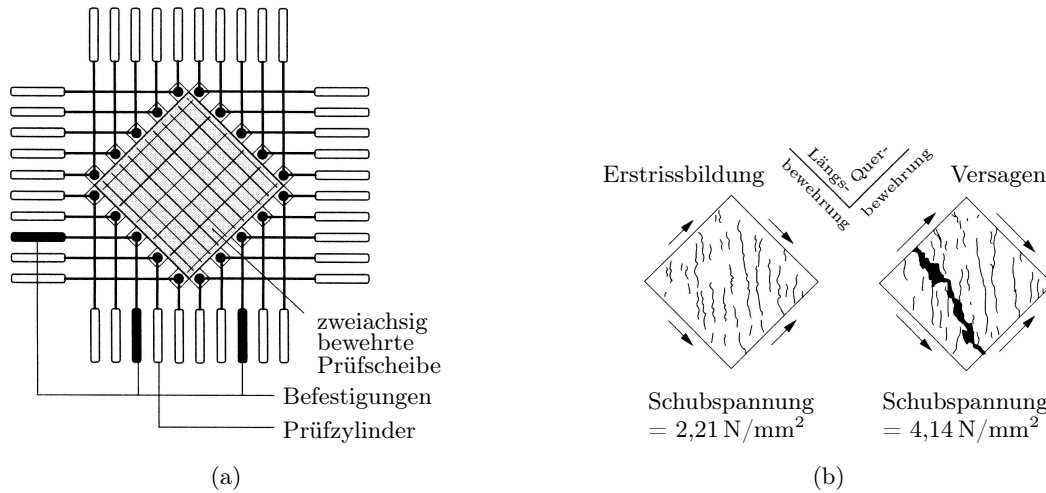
Untersuchungen zum biaxialen Verhalten des bewehrten Betons nach *Vecchio und Collins (1982)* aus (*Pölling 2001*), (a) Versuchsaufbau (b) Drehung der Rissbildung
